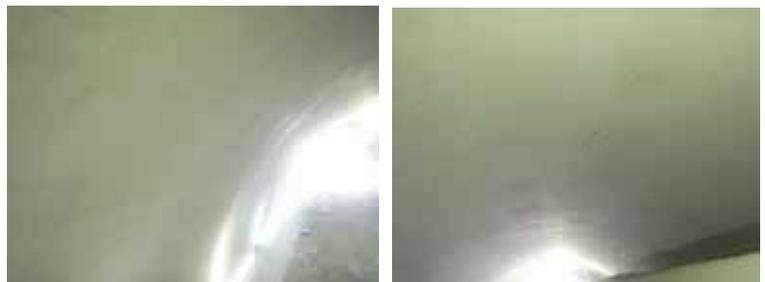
中流動繊維補強覆工コンクリート仕上がり状況
